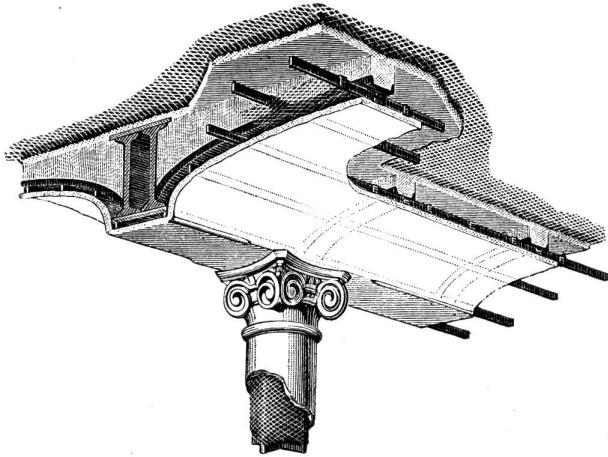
Kassettierte Decke mit Streckmetallbeton.
